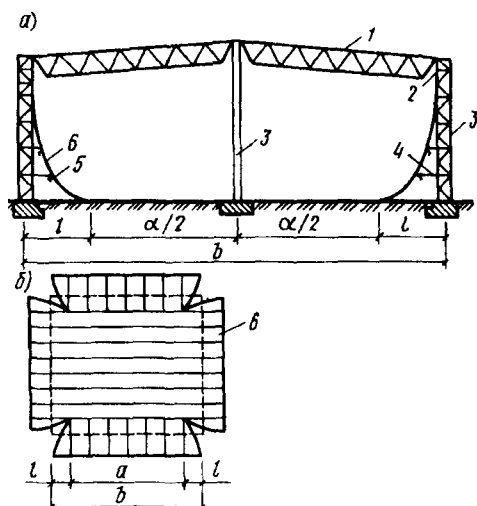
Прямоугольный в плане резервуар с гибкой стенкой
